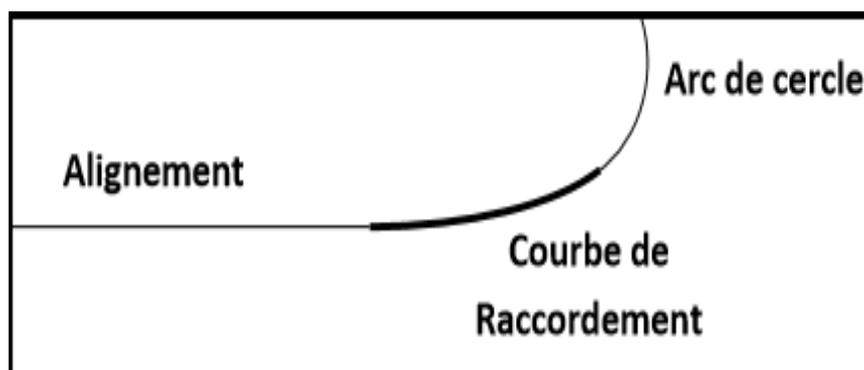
LES ELEMENTS DU TRACE DE PLAN
